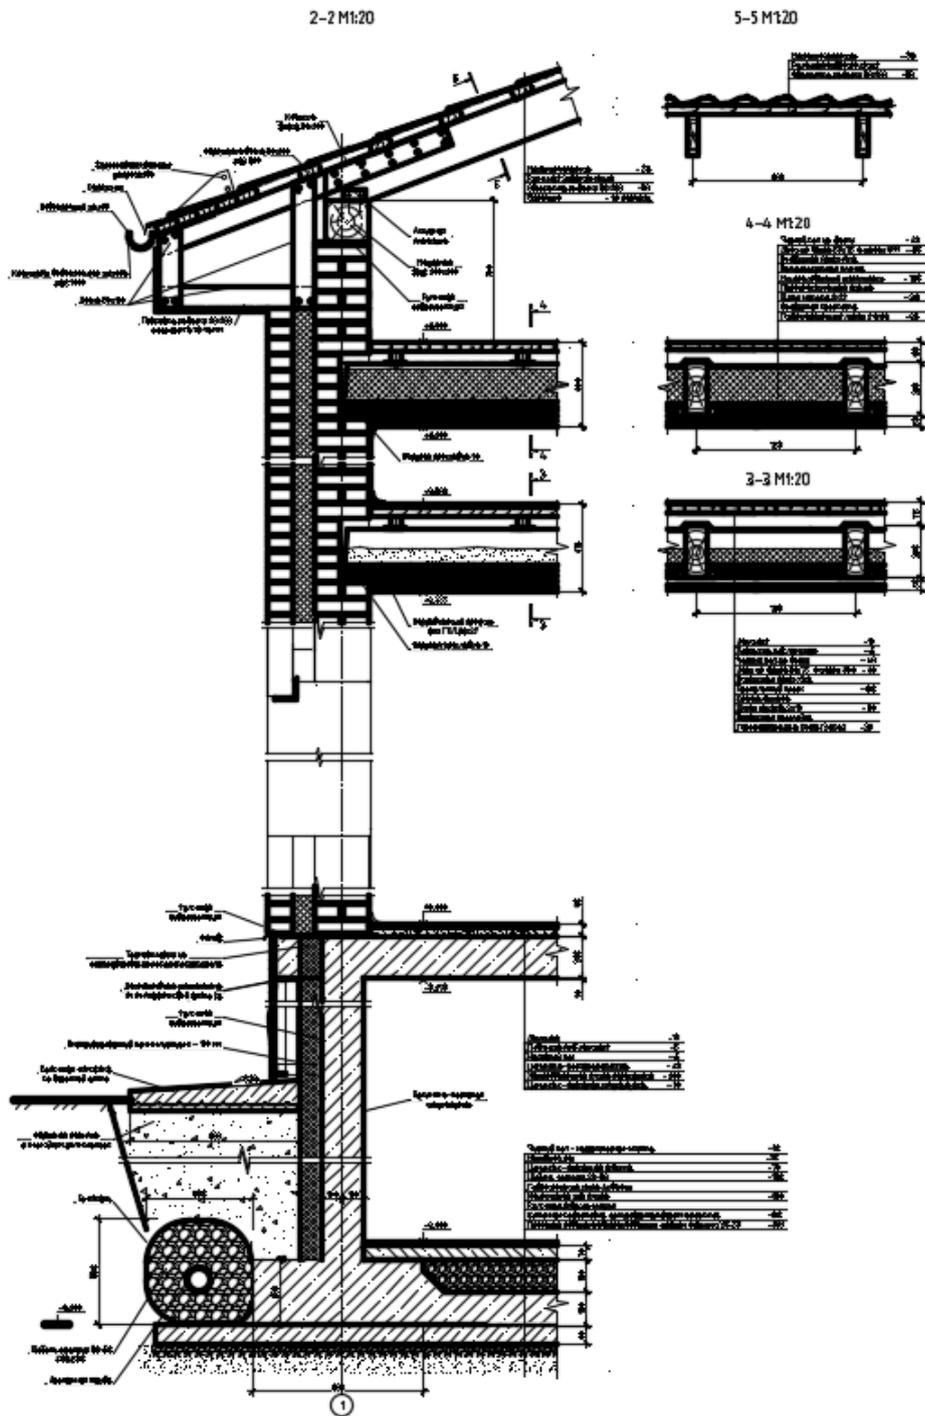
Схема разреза по наружной стене. На этапе разработки планов кровли и стропил поперечный разрез необходимо дополнить конструктивными узлами кровли
